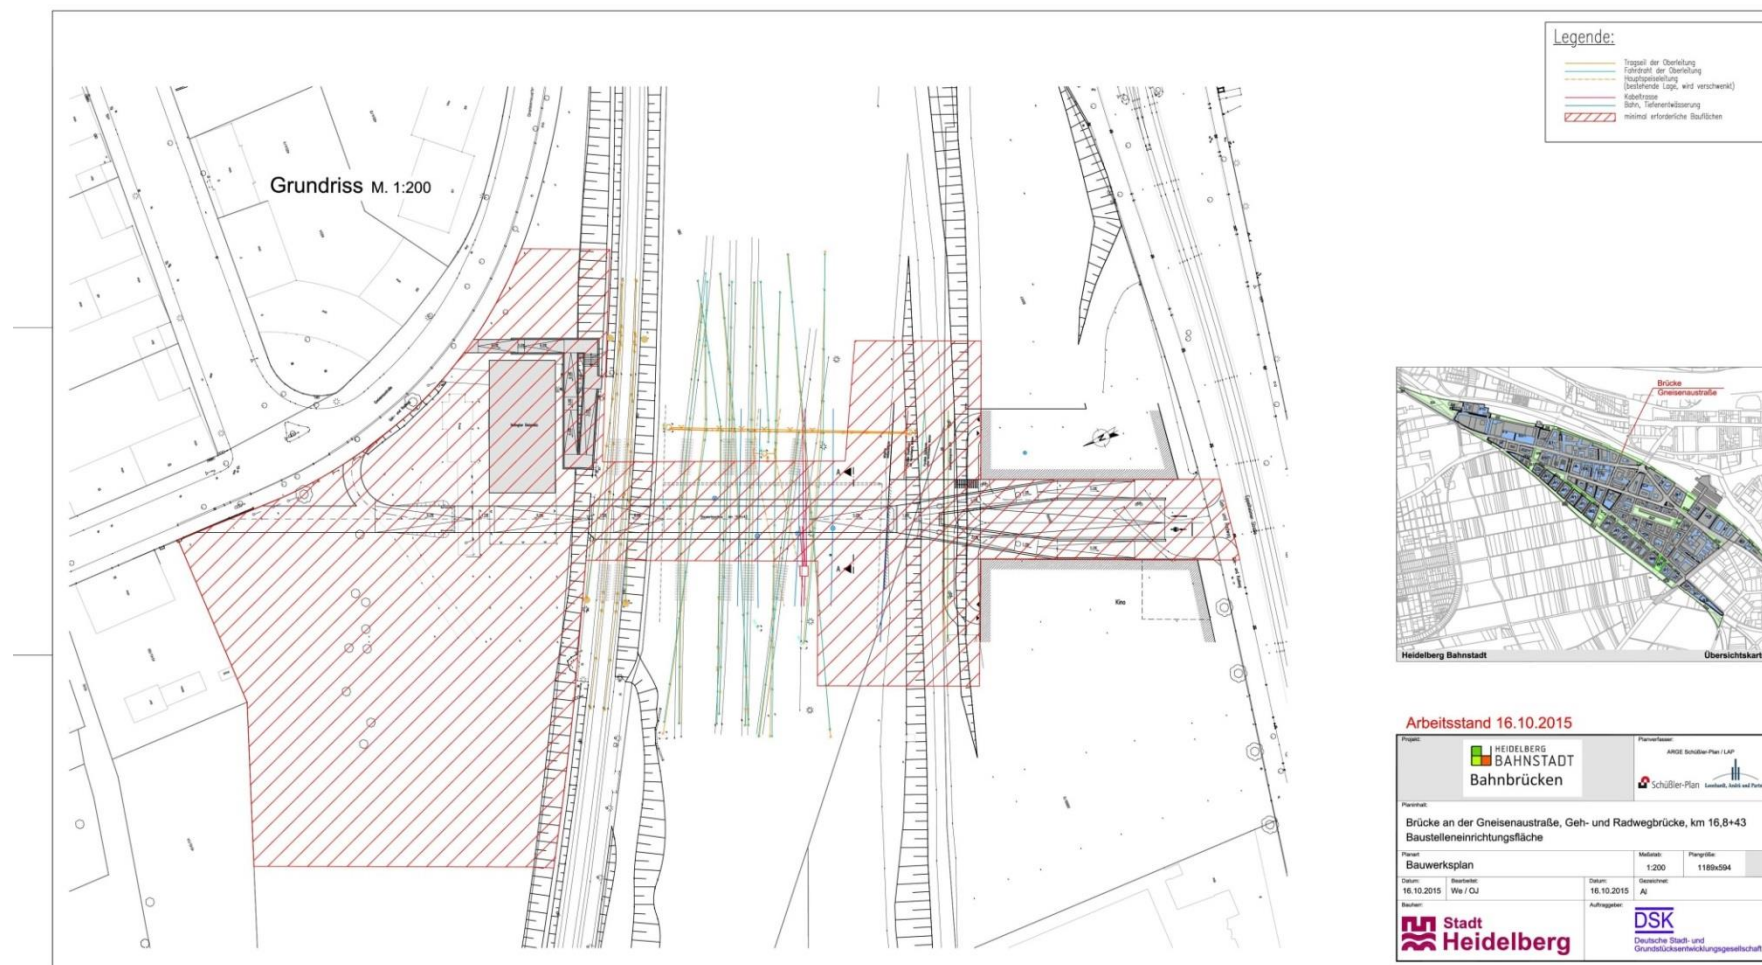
Baufläche einschließlich Baustelleneinrichtungsfläche
